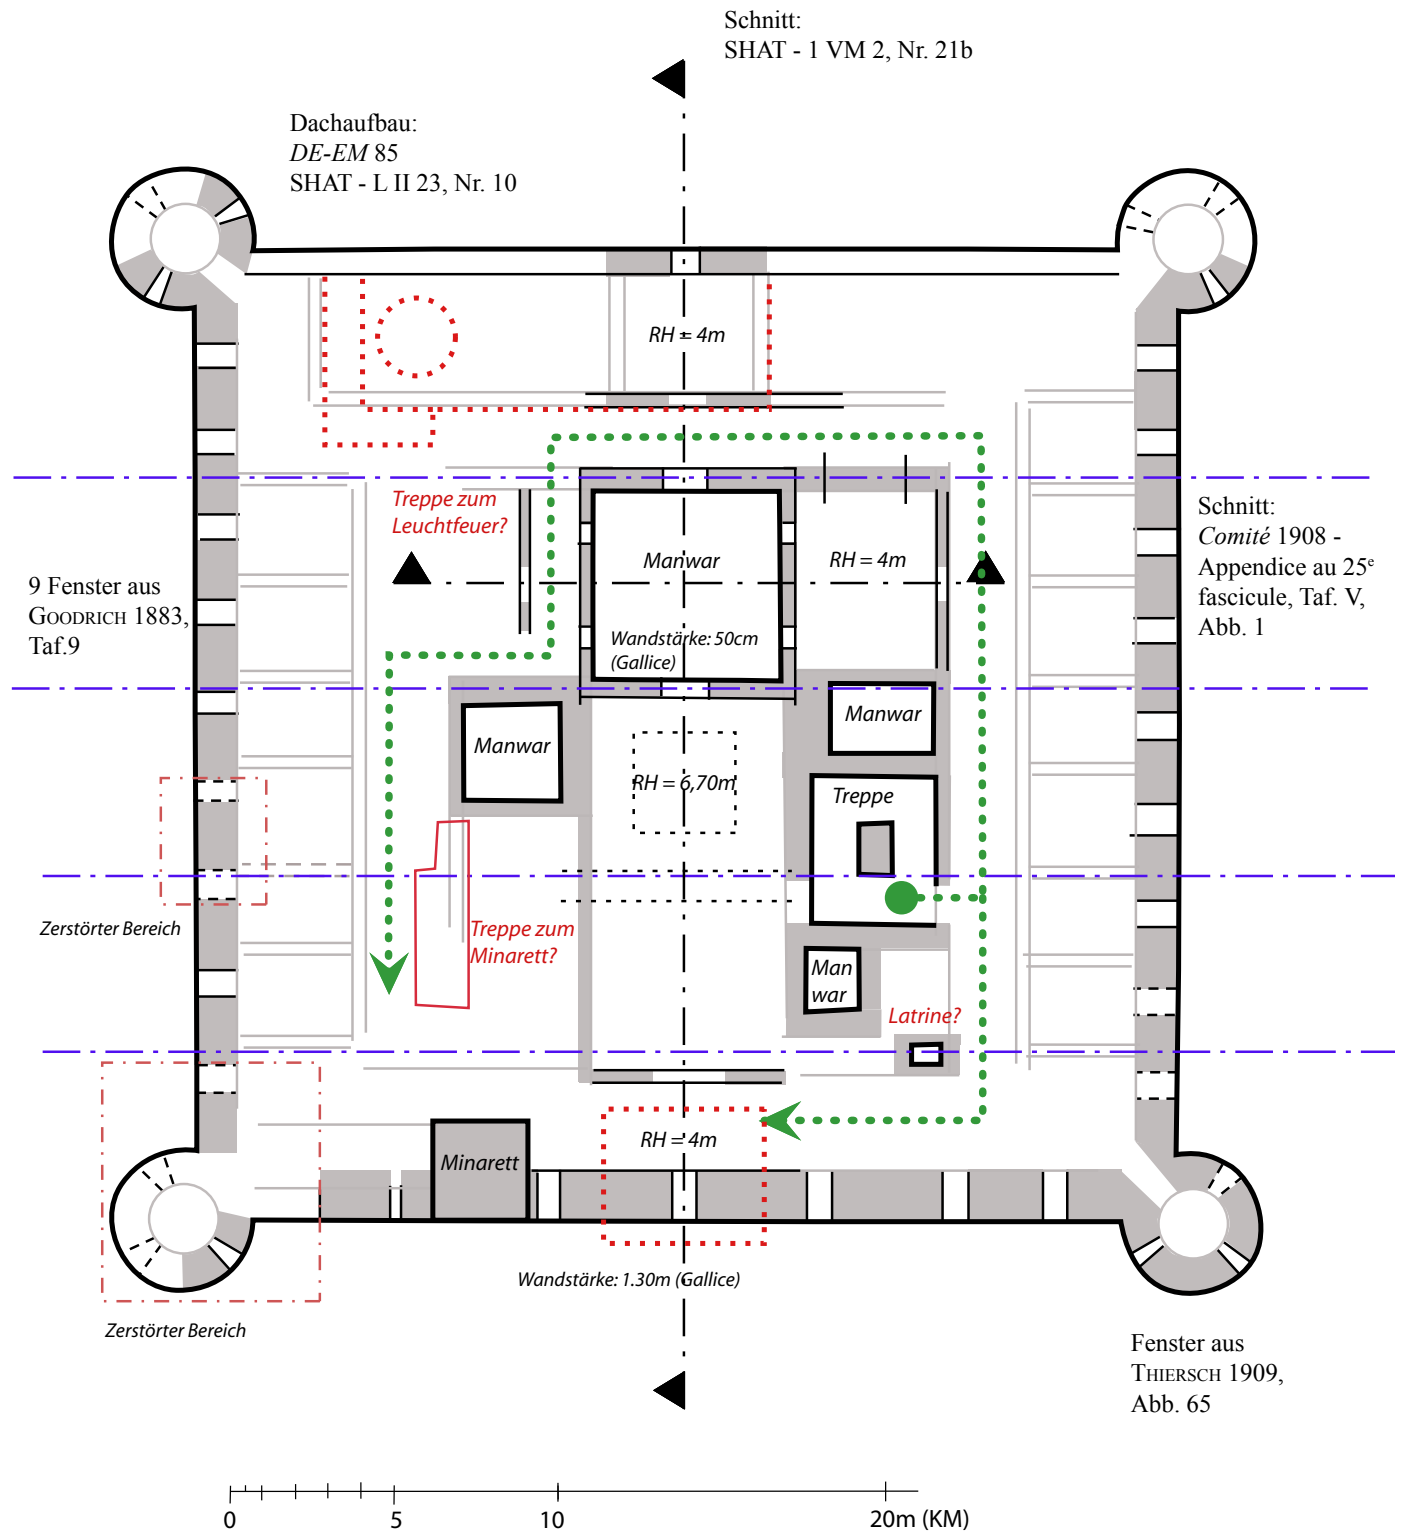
Hauptturm: Grundriss 2. Obergeschoss, Rekonstruktion.
